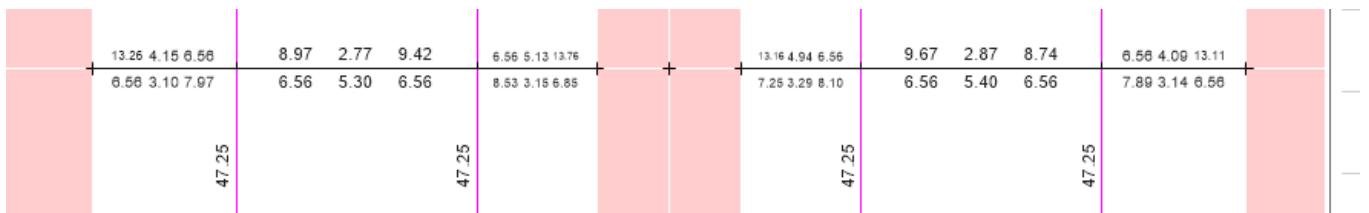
Acero Requerido por momentos en Vigas 6° Piso
